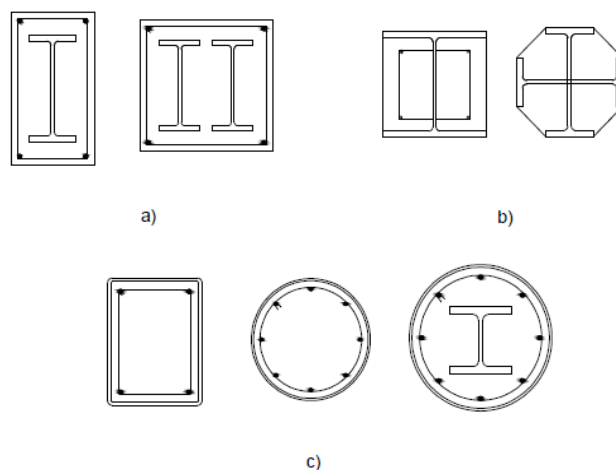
Exemplos de vários tipos de pilares: a) completamente envolvido em betão; b) parcialmente envolvido em betão; c) preenchido por betão (Rodrigues, 2008)
